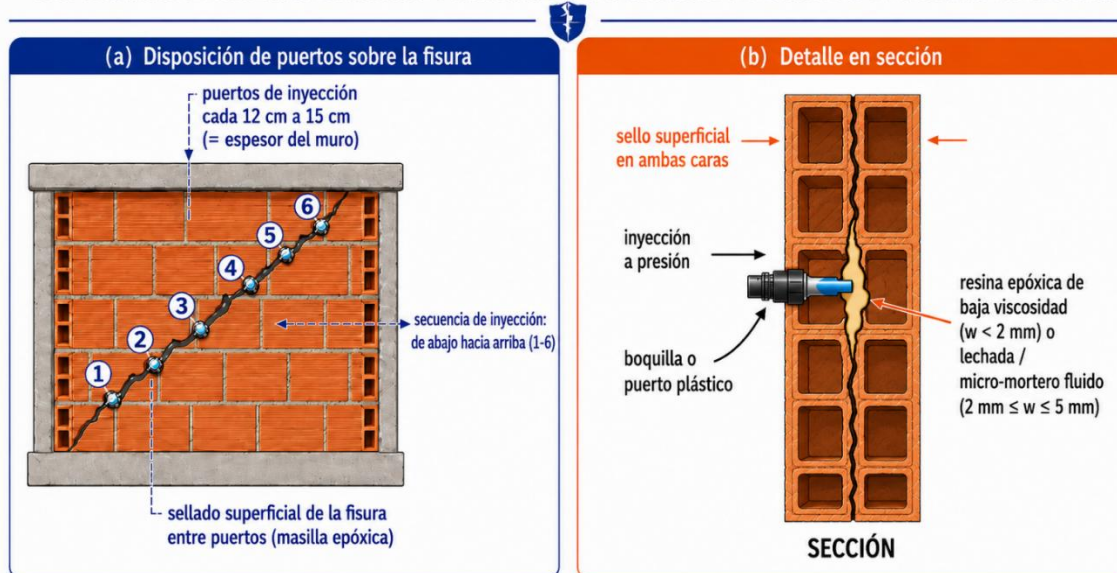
Inyección de fisuras: disposición de puertos y detalle en sección. Fuente: elaboración propia con base en AIS (2001) y Ramírez (2022).
